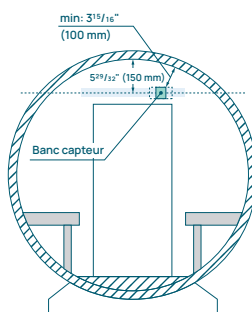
Installation du capteur de sécurité au plafond dans les saunas de type baril : chauffage sur pied
